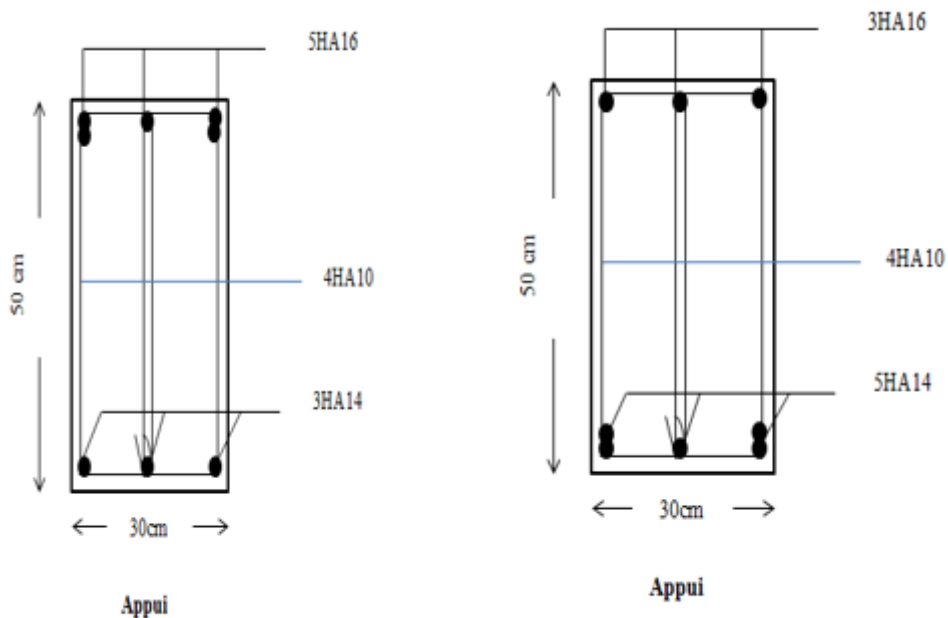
Schéma de ferrailage des poutres porteuses du 7^{ème} étage (TERRASSE).
